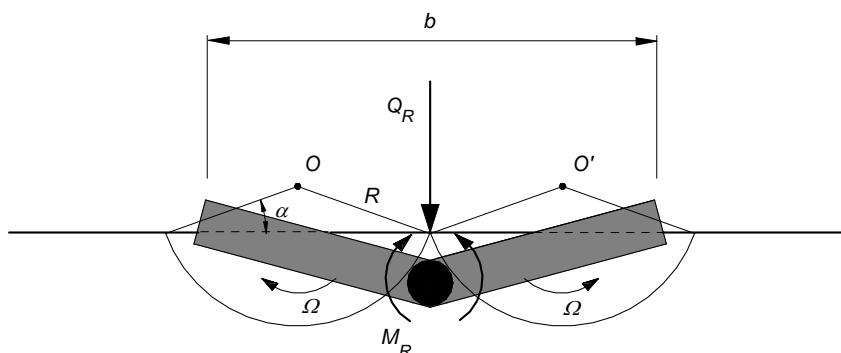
Mécanisme de rupture de la fondation infiniment longue sur sol purement cohésif non pesant en considérant la formation d'une rotule plastique
